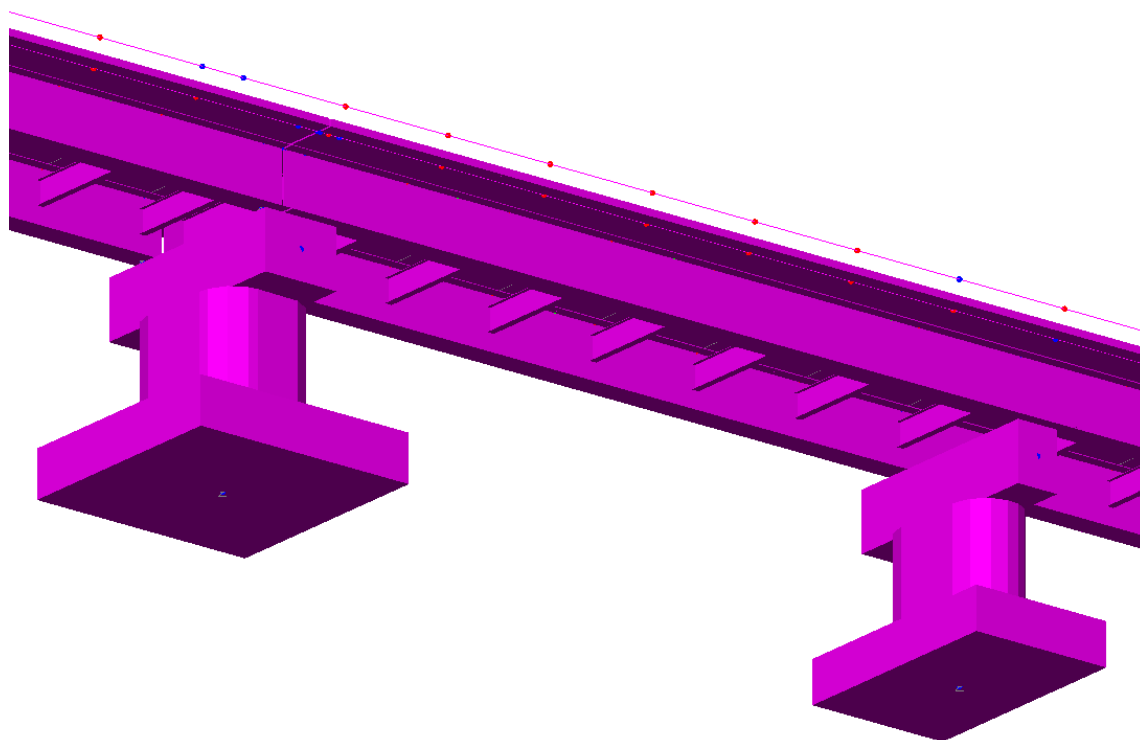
Modello FEM in fase 3 - Particolare zona di testa pila
